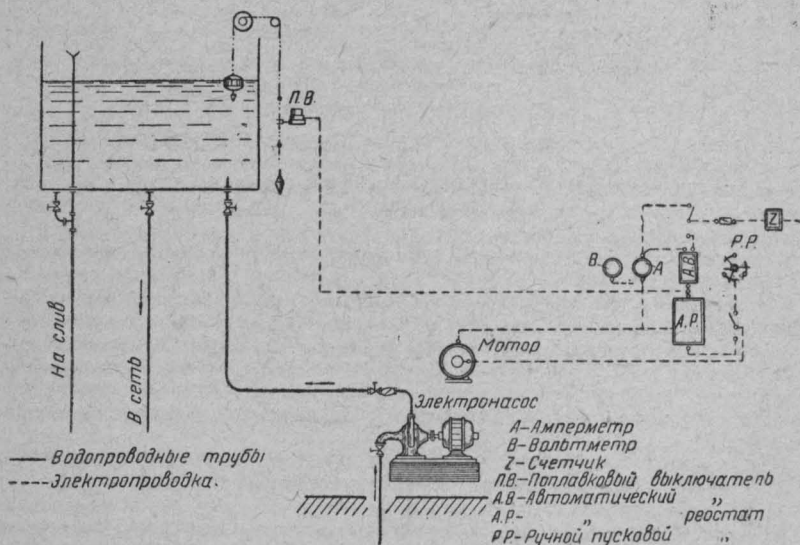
Приспособление для автоматического пуска и остановки насосов.
